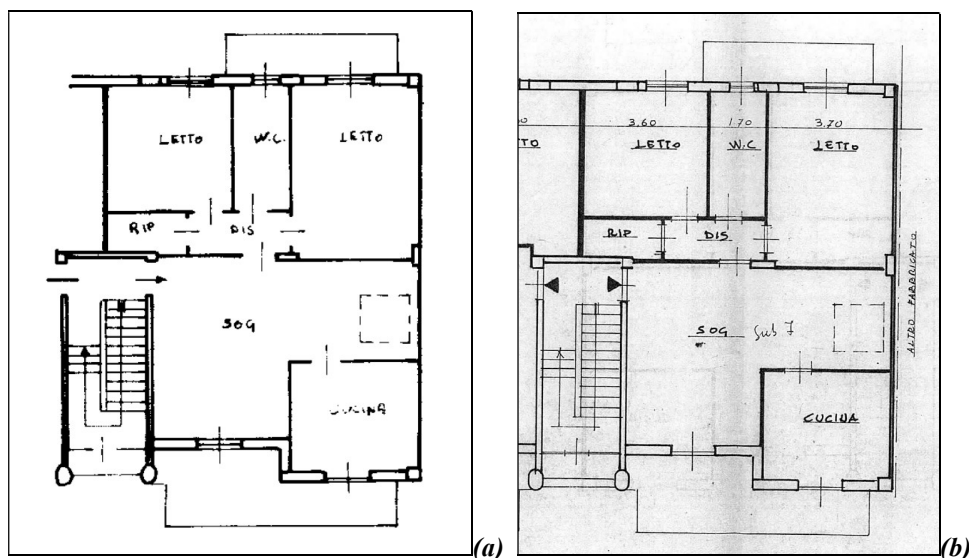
Planimetria dell'appartamento ubicato in via Leonardo Cera n° 7 – interno 4 piano 2: planimetria catastale (a); planimetria di progetto (b).
